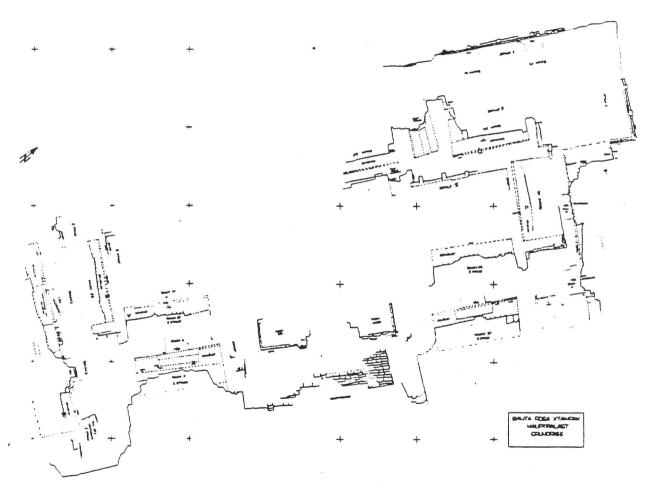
Teil des detailliert hochgezeichneten Grundrisses. Es entsteht ein räumlich unvollkommen auffaßbares Modell des Objekts.
